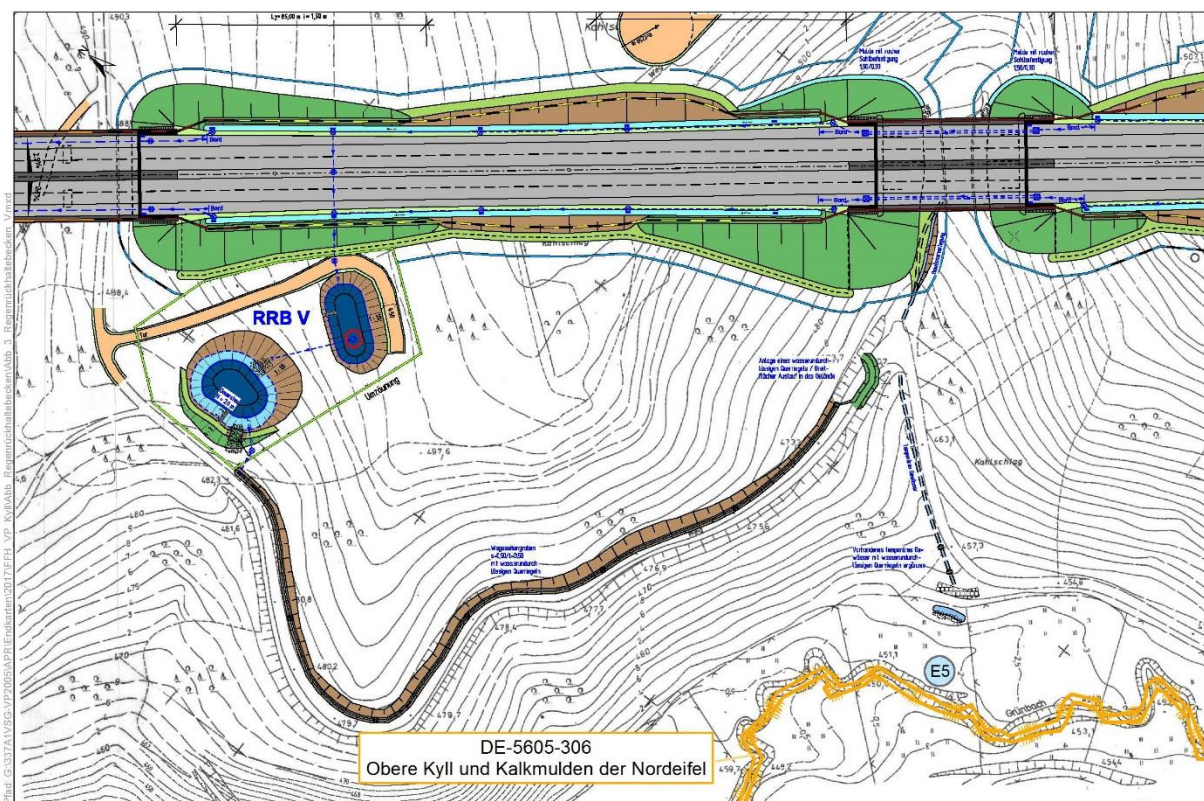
Regenrückhaltebecken V und Entwässerungsplanung (Ausschnitt Lageplan 10 Unterlage 5)
